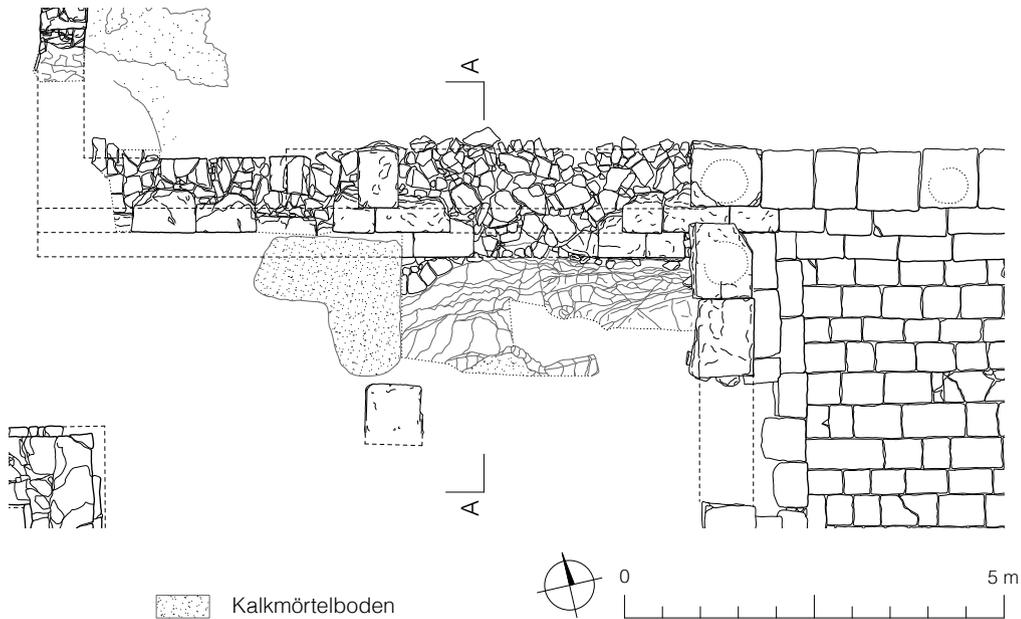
Westabschluss der Nordhalle mit Nordteil der Westhalle, Steinplan 2021 (M. 1:100)
